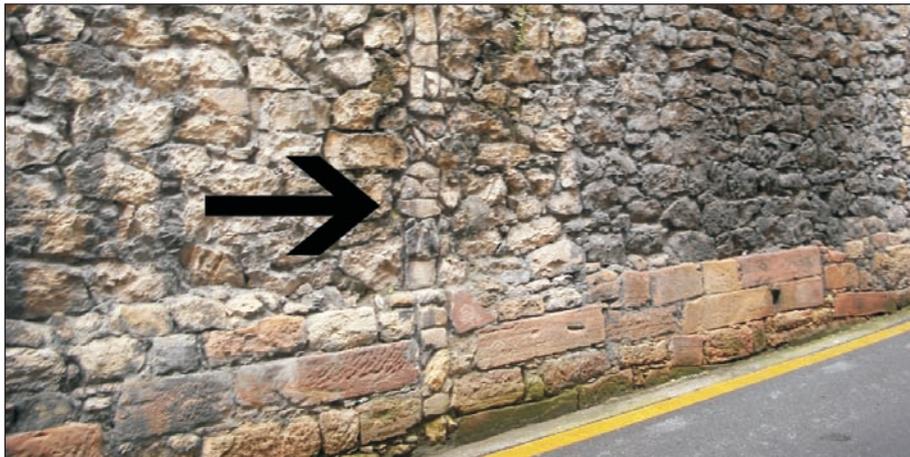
Tramo de banqueta con cantería de arenisca apreciado en la muralla del Paraíso (foto inferior) y grieta estructural señalada por la flecha
